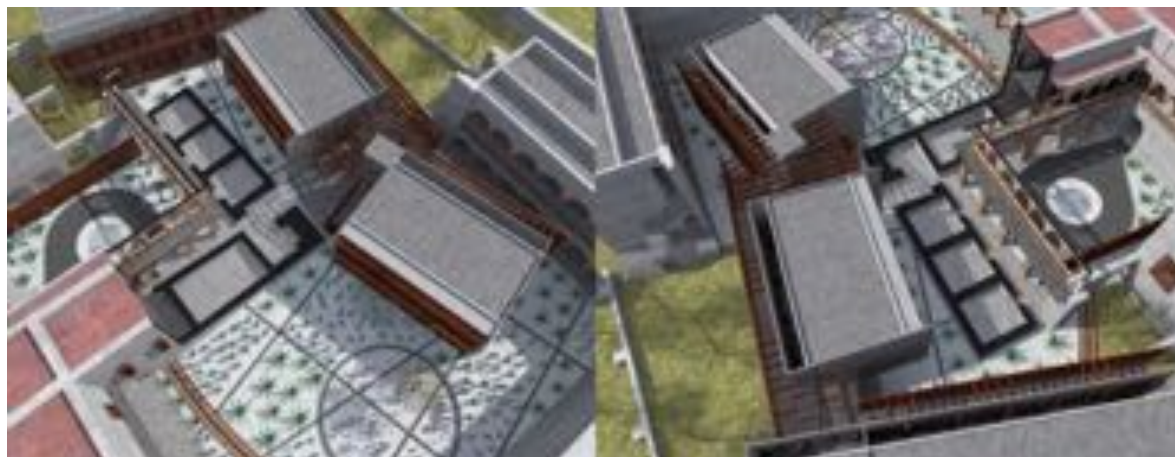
y 76. Vistas de propuestas de integración del nuevo conjunto arquitectónico.
